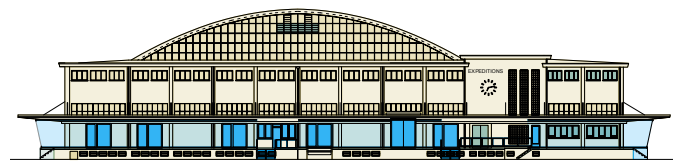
plans phases de construction coupe transversale, façades ouest et est
